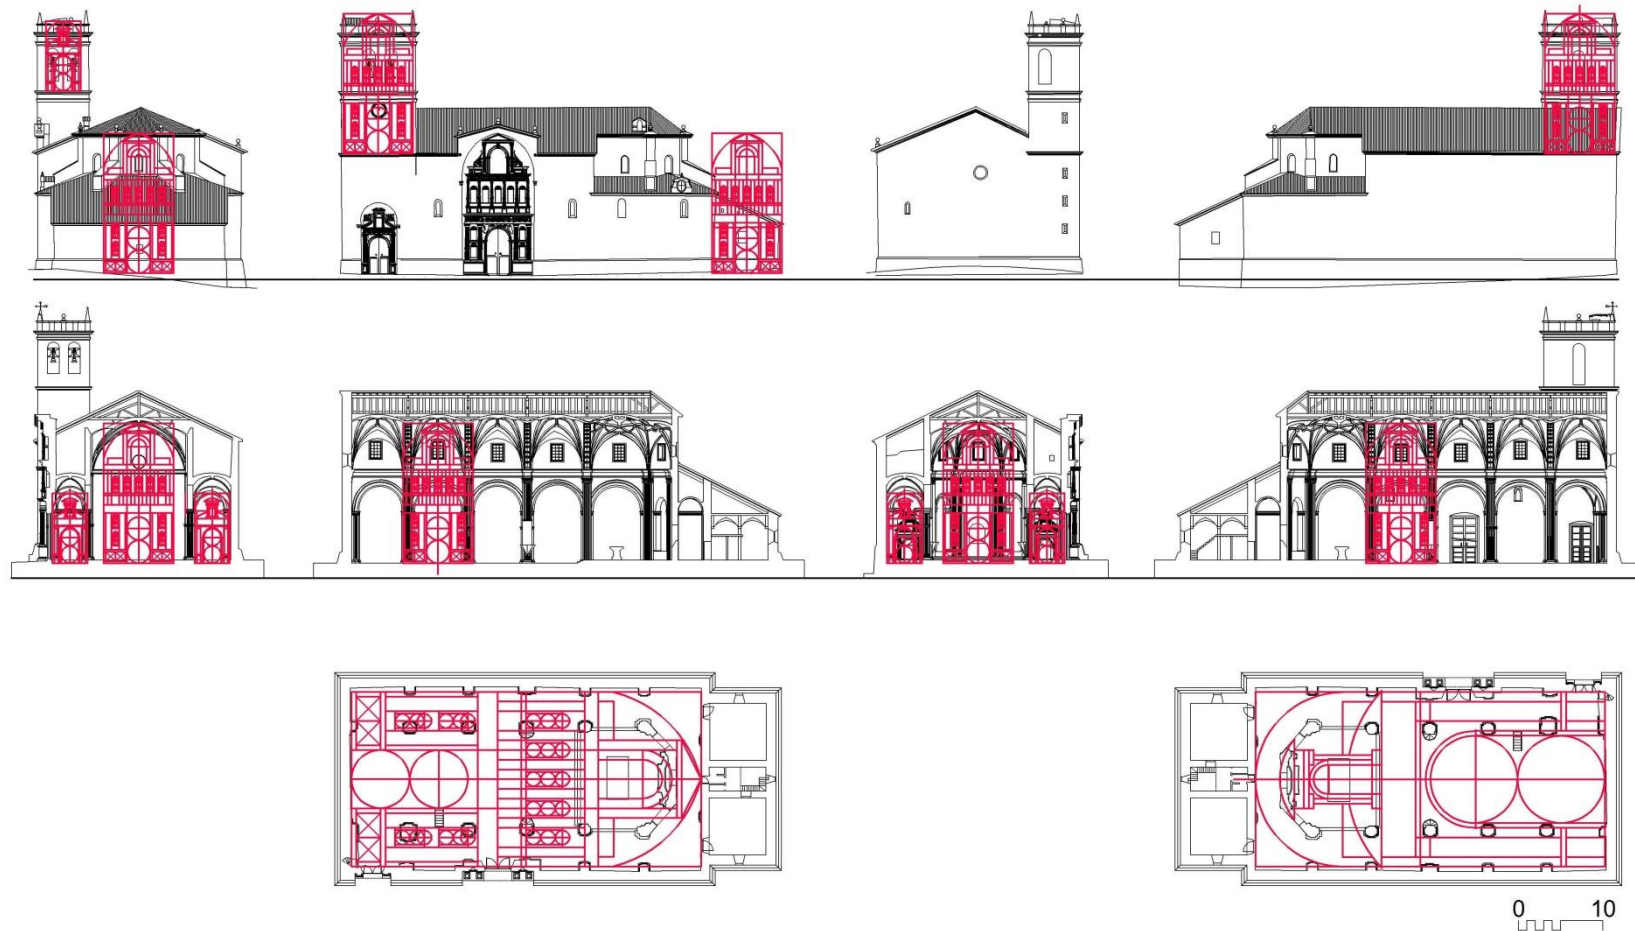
Correspondencia del esquema de las portadas con el resto del edificio.
